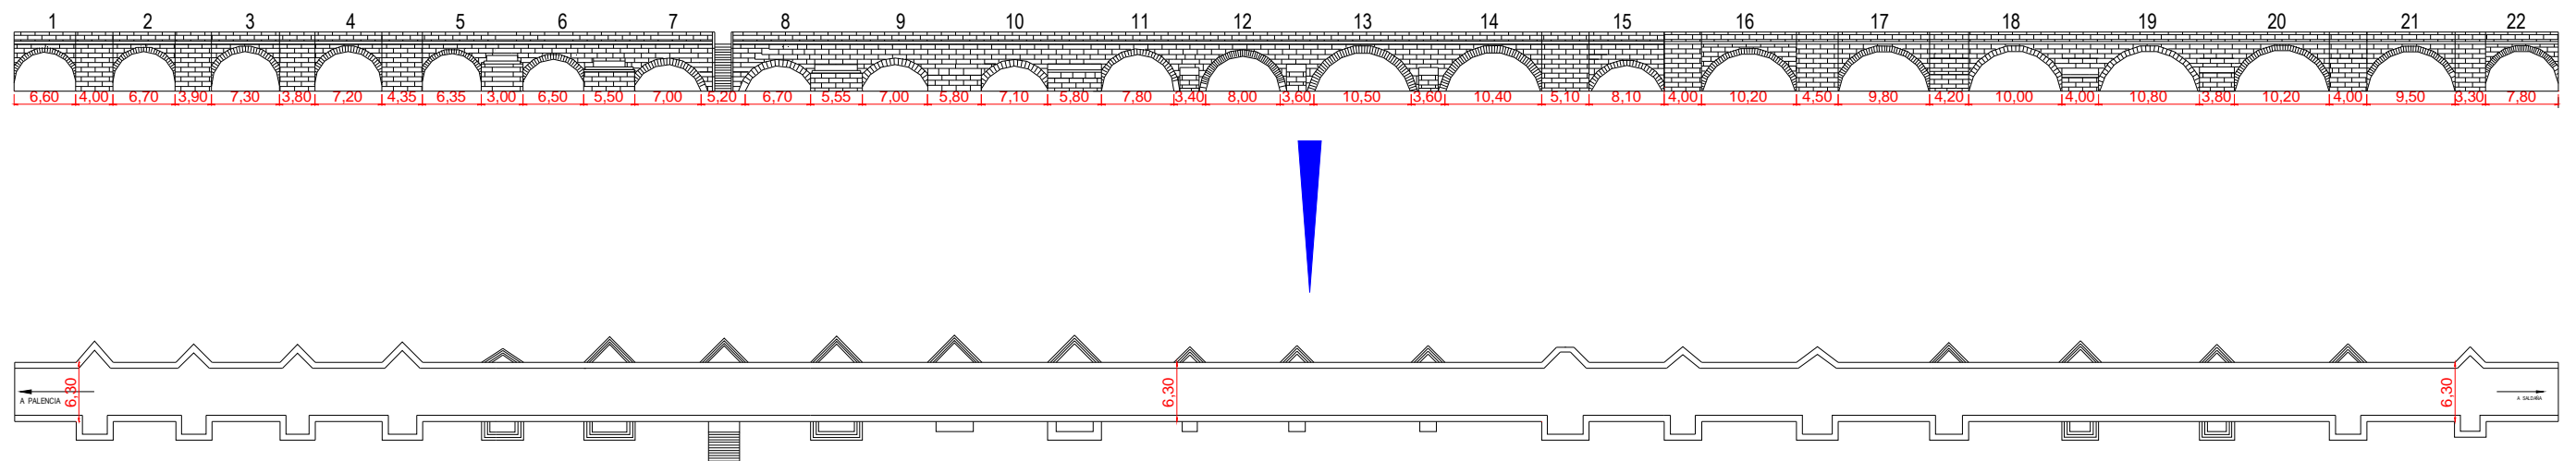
Planta y alzado de aguas abajo del puente en Saldaña
